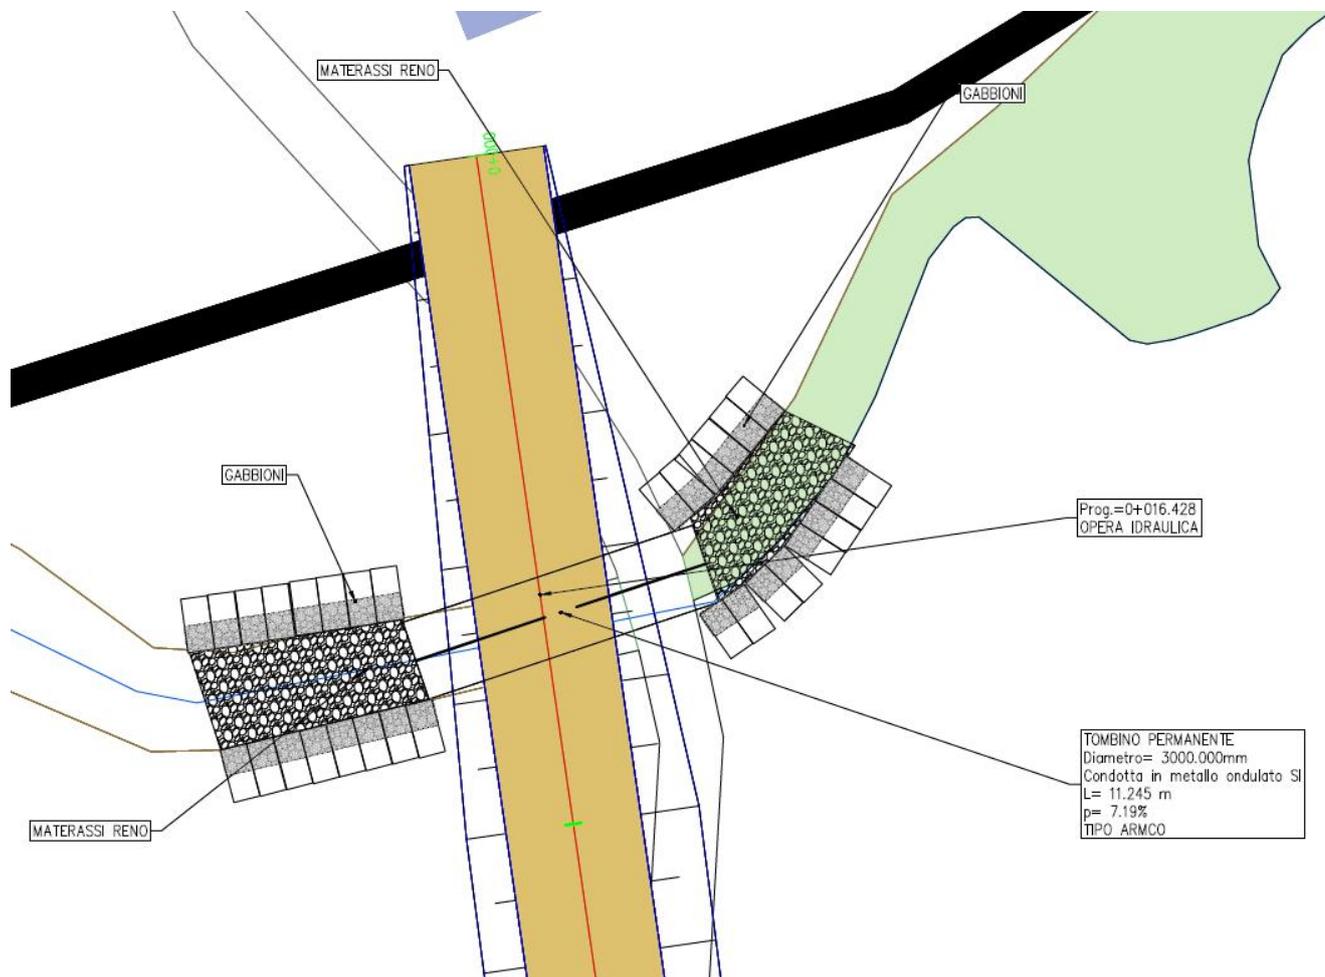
Dettagli risoluzione interferenze – viabilità definitiva (F0626AT10A - A.16.a.21 - Planimetria della sistemazione finale sito).
